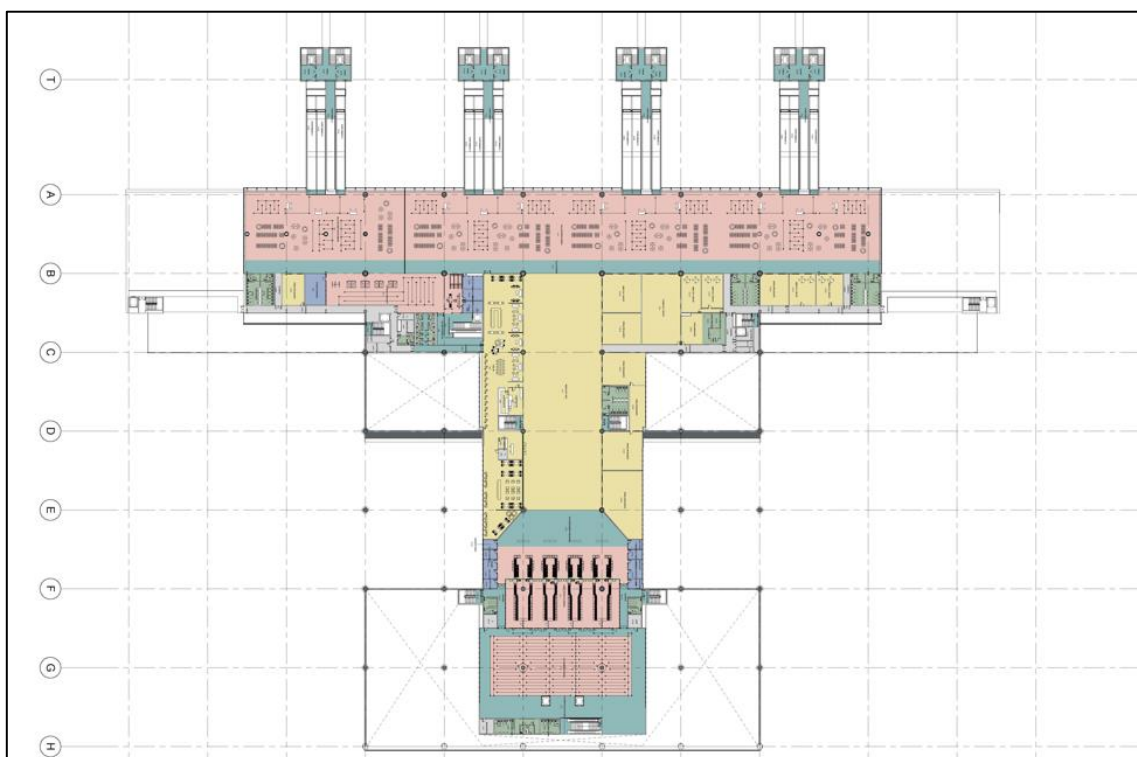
| Planimetria Piano Primo 2026 – Zoning delle aree
